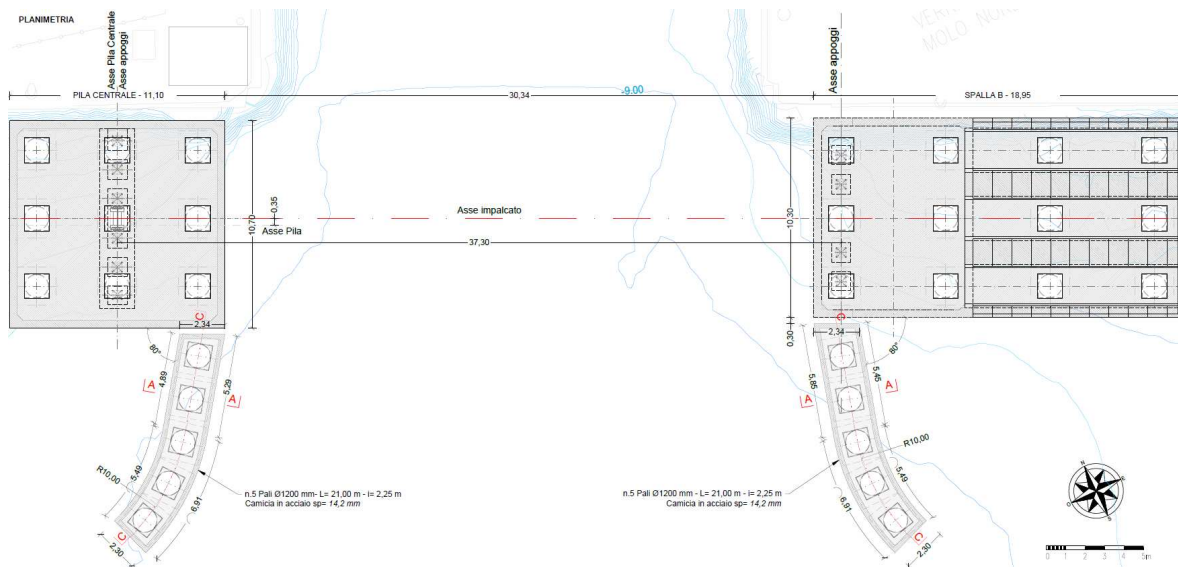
Opere di protezione delle sottostrutture del ponte: planimetria strutturale
